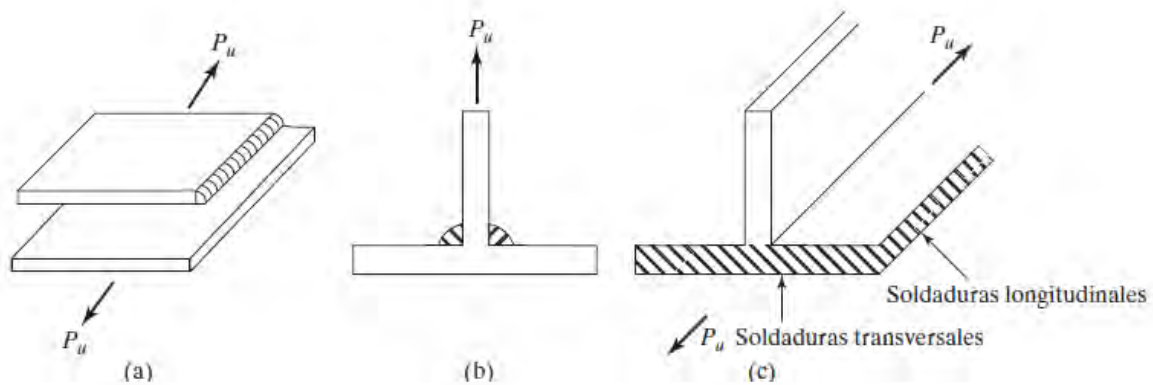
(a) Soldadura de filete longitudinal. (b) Soldadura de filete transversal.
